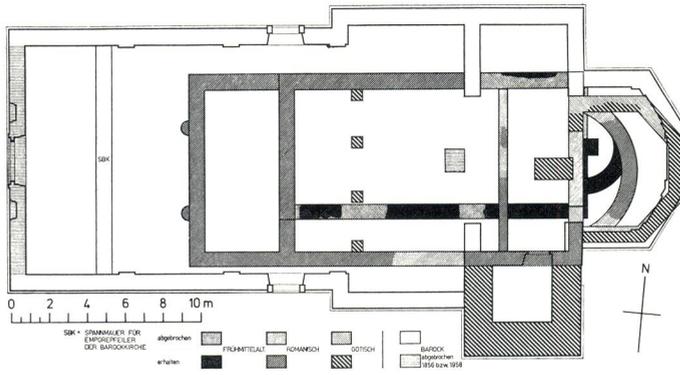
Tuggen. Kath. Pfarrkirche. Bautappenplan mit den Grundrissen der Vorgängerbauten: Romanisch (11./12. Jh.), merowingisch (650/60) mit dem Stiftergrab.
